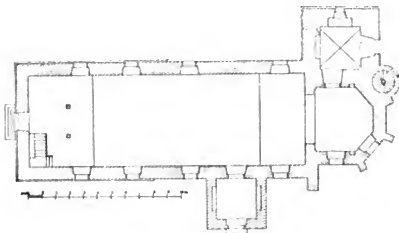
Skoritz. Grundriss des Schlosses.
